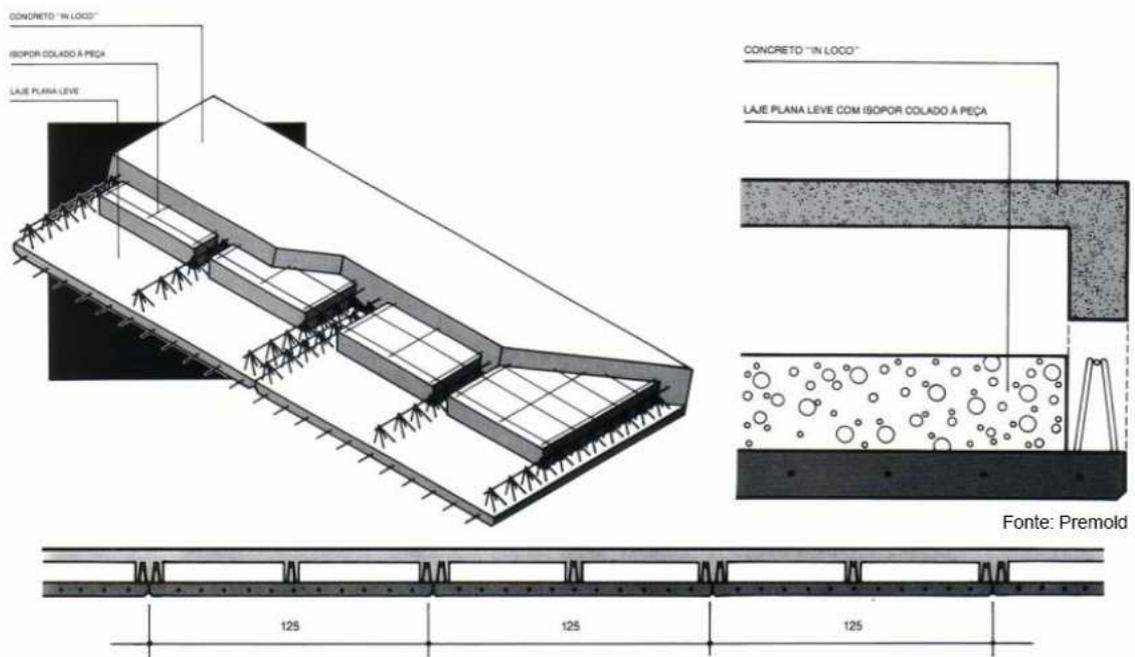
Lajes Plana leve (KLEIN, VARGAS, VOGES, 2010)
